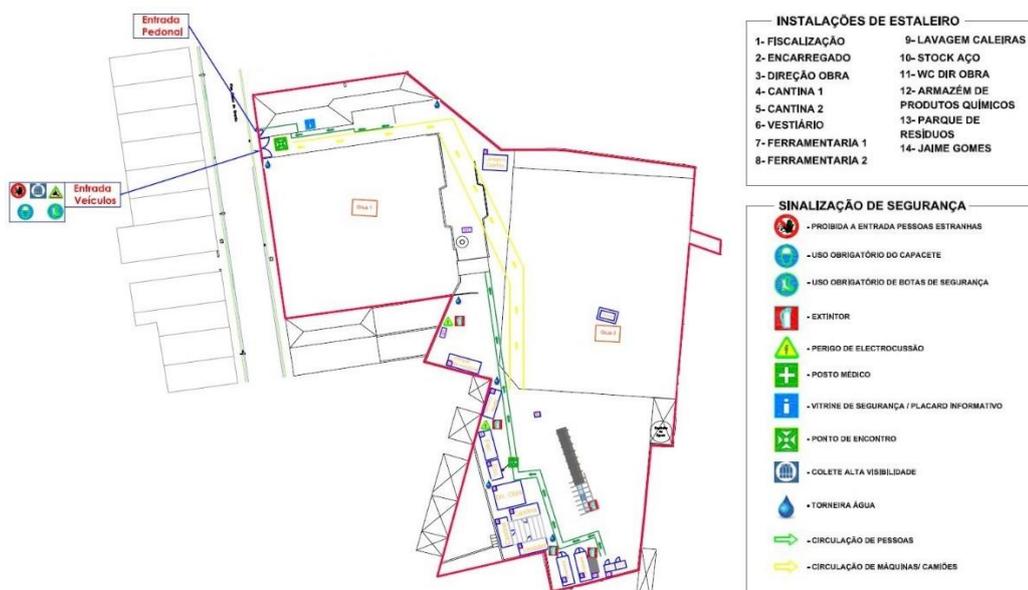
Planta de Estaleiro, Fonte Projeto de Estaleiro.
